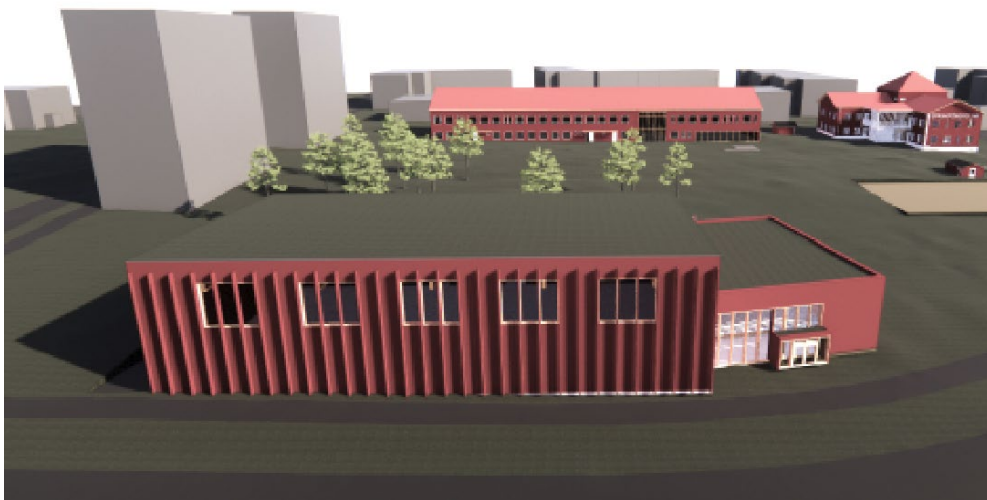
Bildkollage som visar placering av idrottshall mot Istidsgatan i planområdets södra del samt urklipp från Detaljplan för Stadsliden 6:2, samrådshandling 2023. Källa: White.
